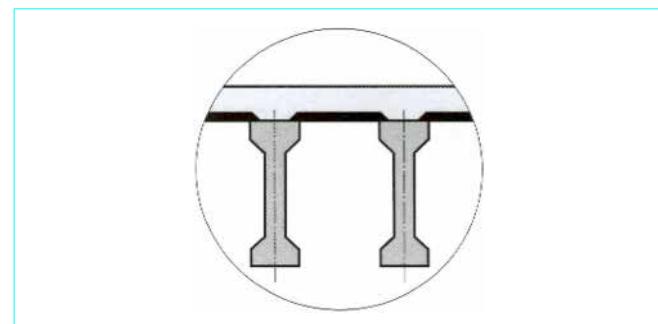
Coupe schématique d'un tablier à poutrelles précontraintes par pré-tension
